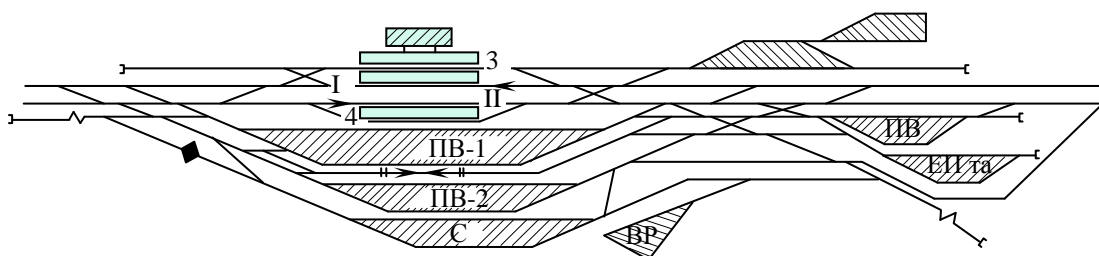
Принципова схема розташування пристроїв на дільничній станції
